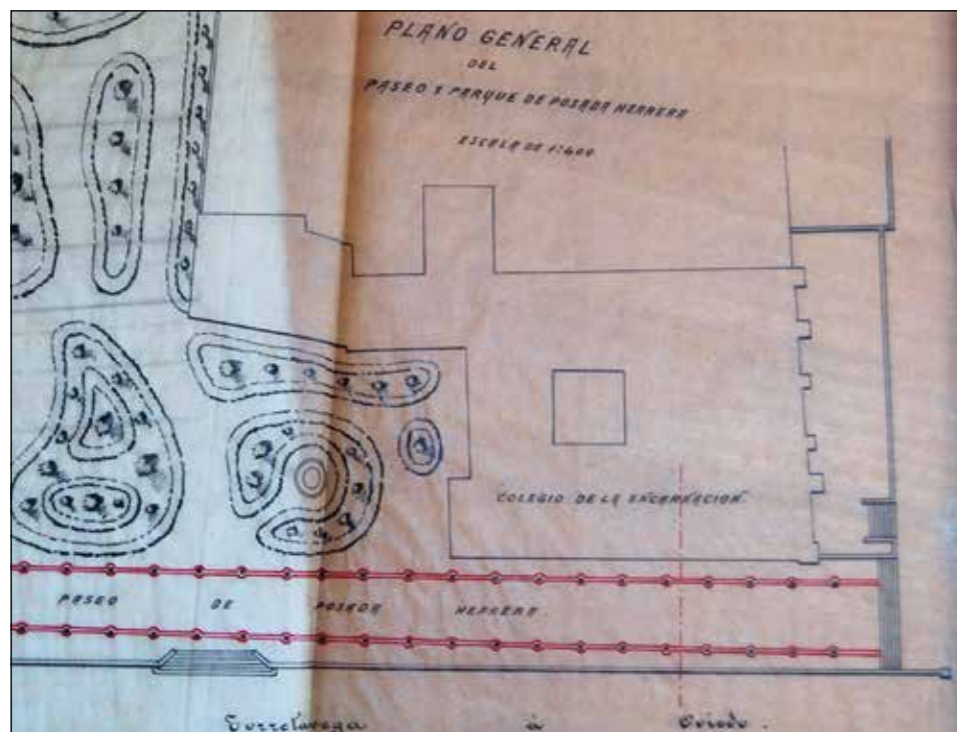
En el centro del plano de aprecia la planta del antiguo edificio conventual en 1908. Plano del Proyecto de construcción de dos cunetillas en el Paseo de Posada Herrera. Caja 125. Archivo Histórico de Llanes.
